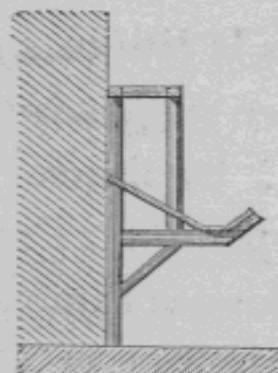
Coupe de la crèche simple de M. le comte de Kerorlay, à Canisy.
